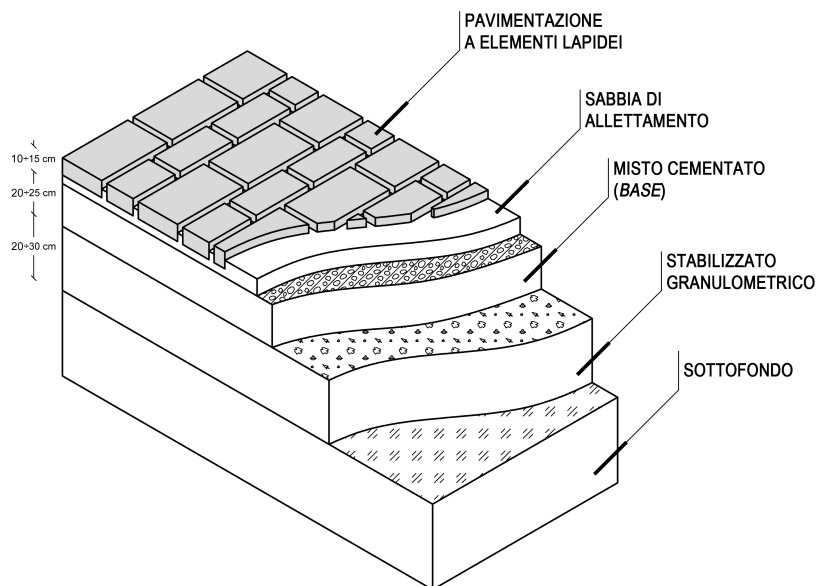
Sezione di una pavimentazione stradale semirigida con sovrastuttura in elementi lapidei
